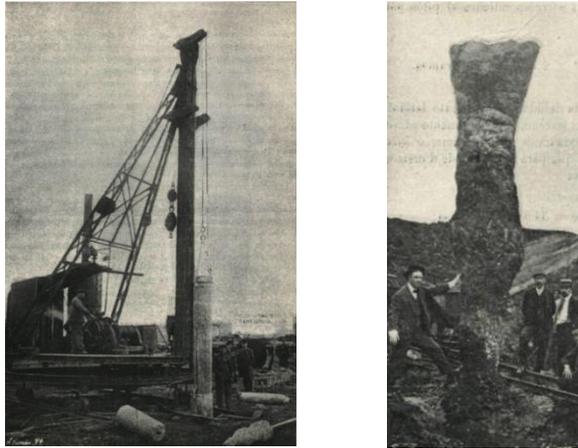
Pilotes armados Frankignoul (Gallego, 1912)
